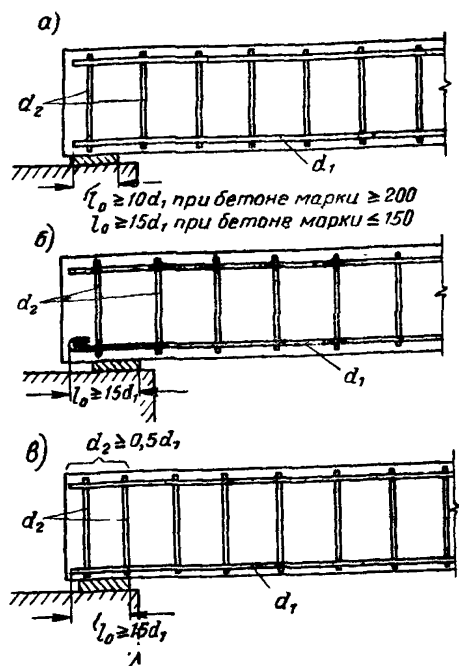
Анкеровка продольной рабочей арматуры на свободных опорах балок в случаях, когда поперечная арматура требуется по расчету, т. е.
